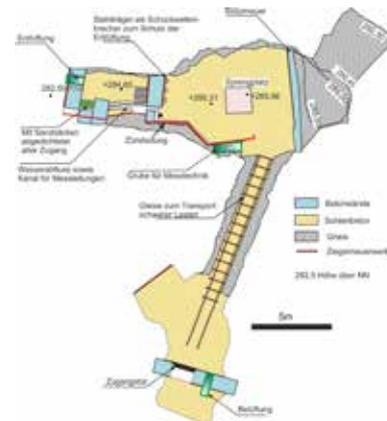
Schematischer Grundriss des SWL (2019)
